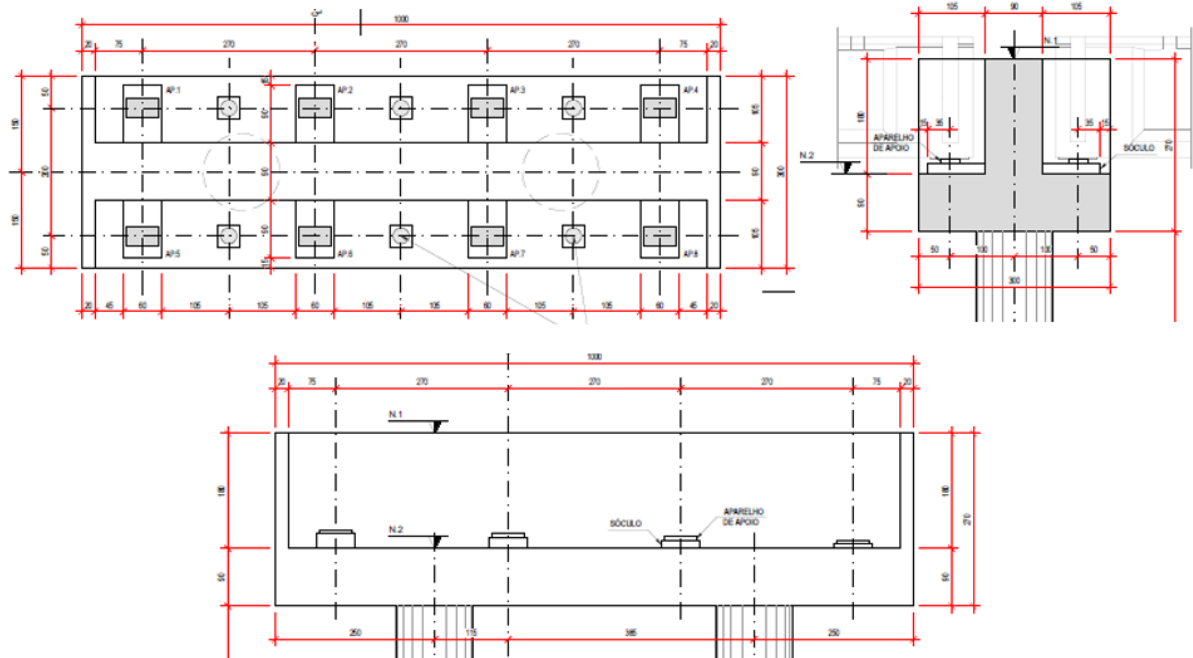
SEÇÕES TRAVESSAS (EIXOS E2, E10 AO E18)
